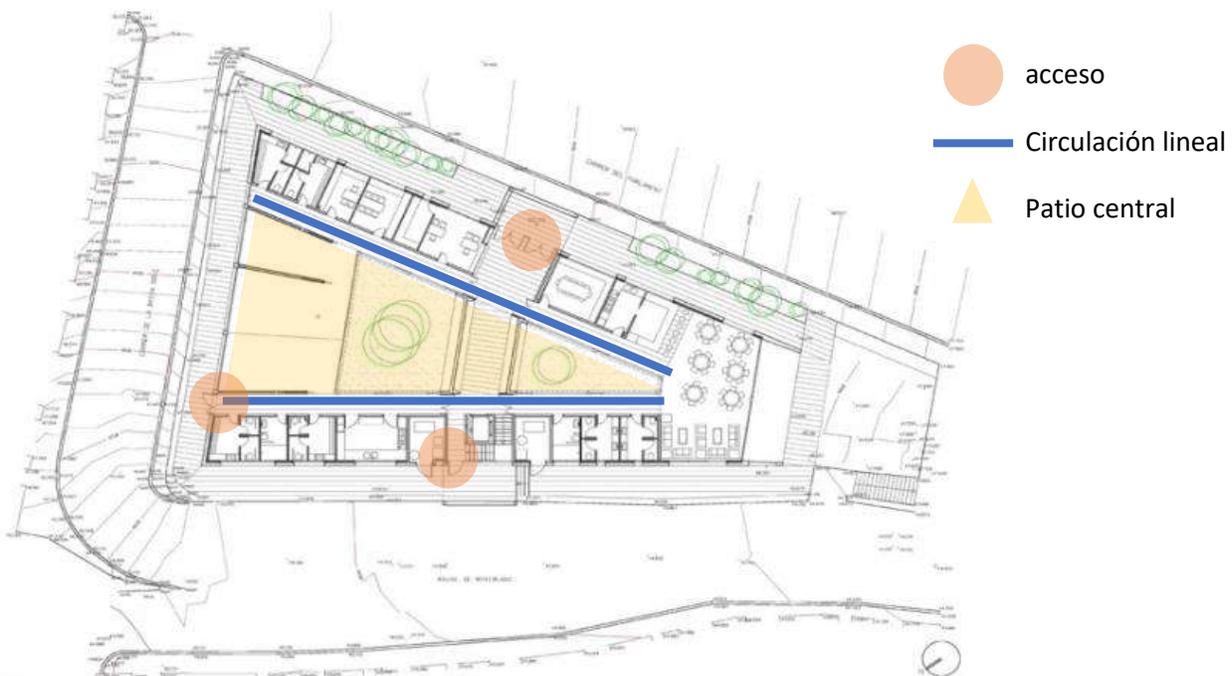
Planta Arquitectónica Centro de día y hogar para ancianos. Fuente: www.archdaily.mx/mx
